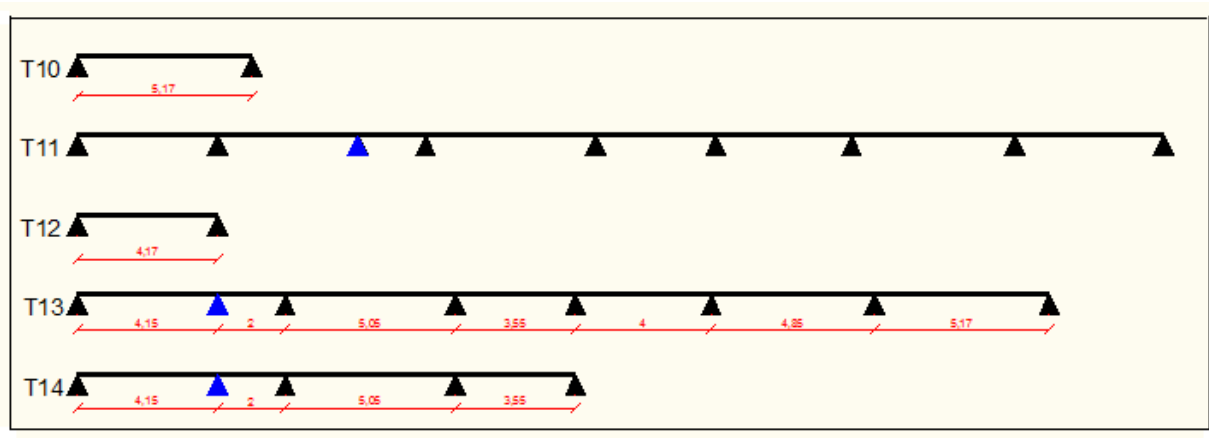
schéma statique des poutrelles de la terrasse inaccessible.
